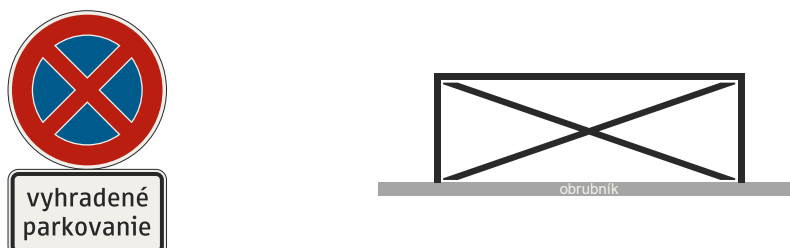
Príklad vyznačovania vyhradených parkovacích miest
